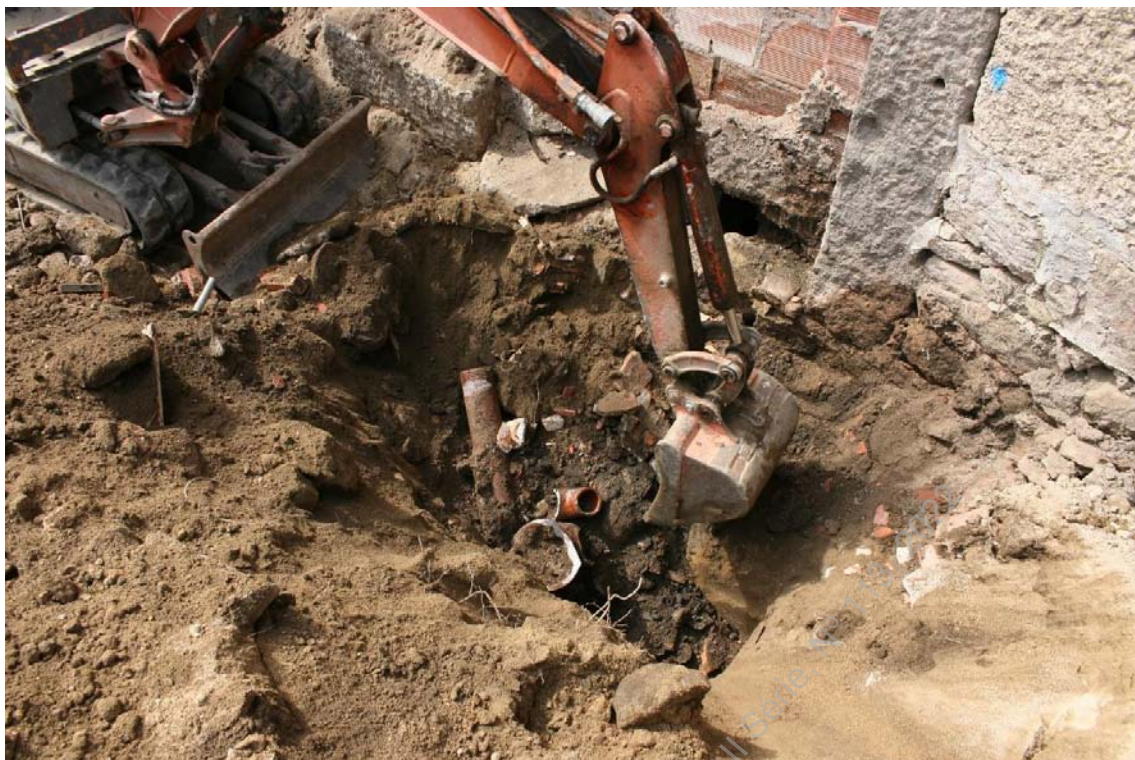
(IMG_5523) – Aspeto de escavação de vala zona nordeste.
